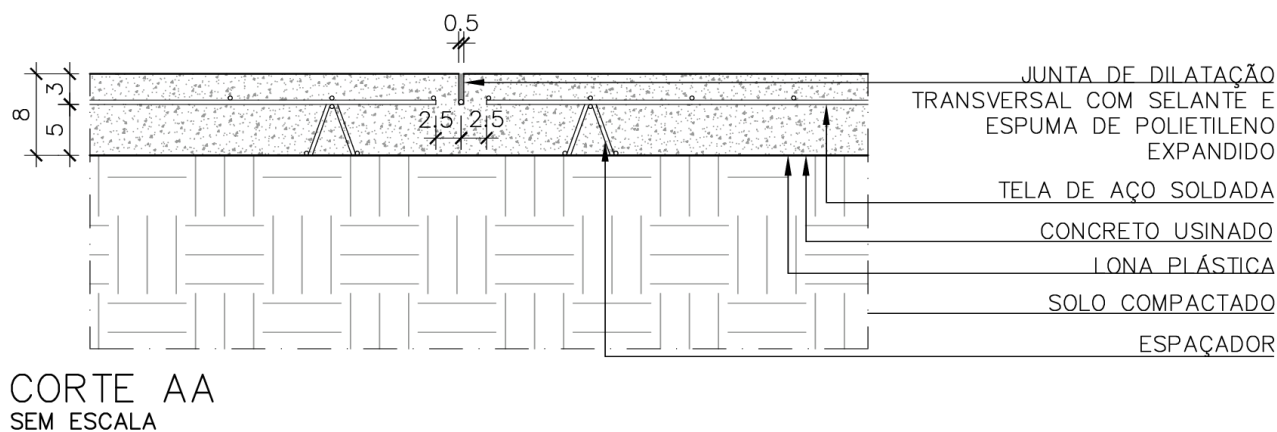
Corte transversal piso mecanizado. Fonte: Elaboração própria. Nota: Desenho elaborado em 09/11/2022.
